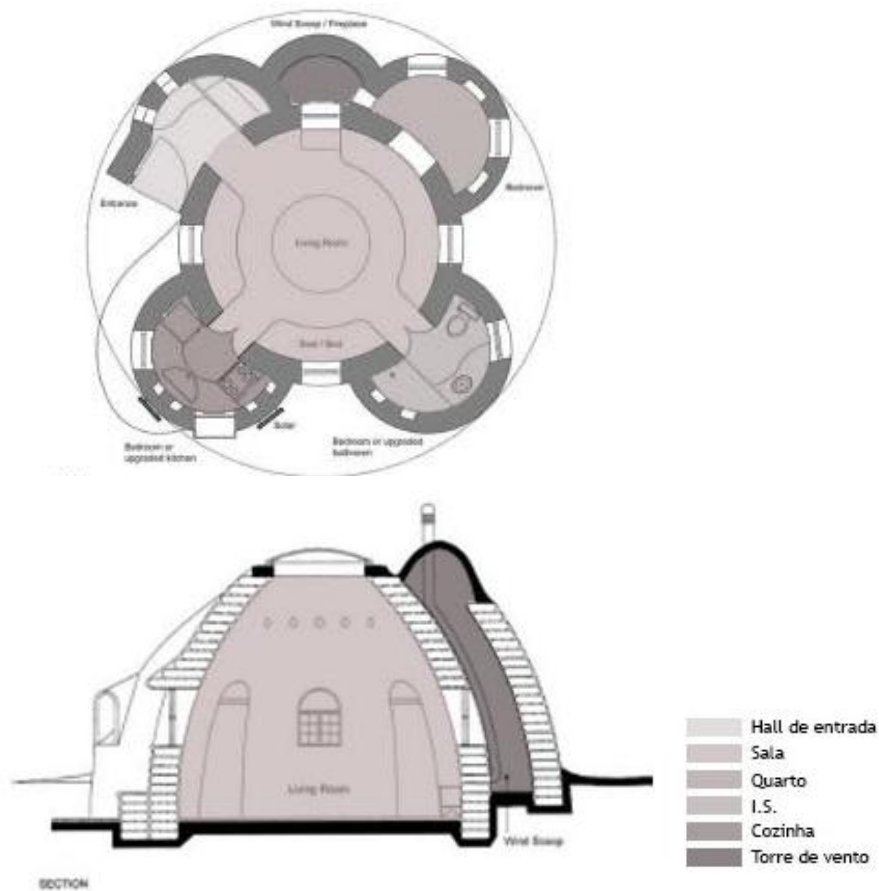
Planta (em cima) e Corte (em baixo) “Superadobe”
